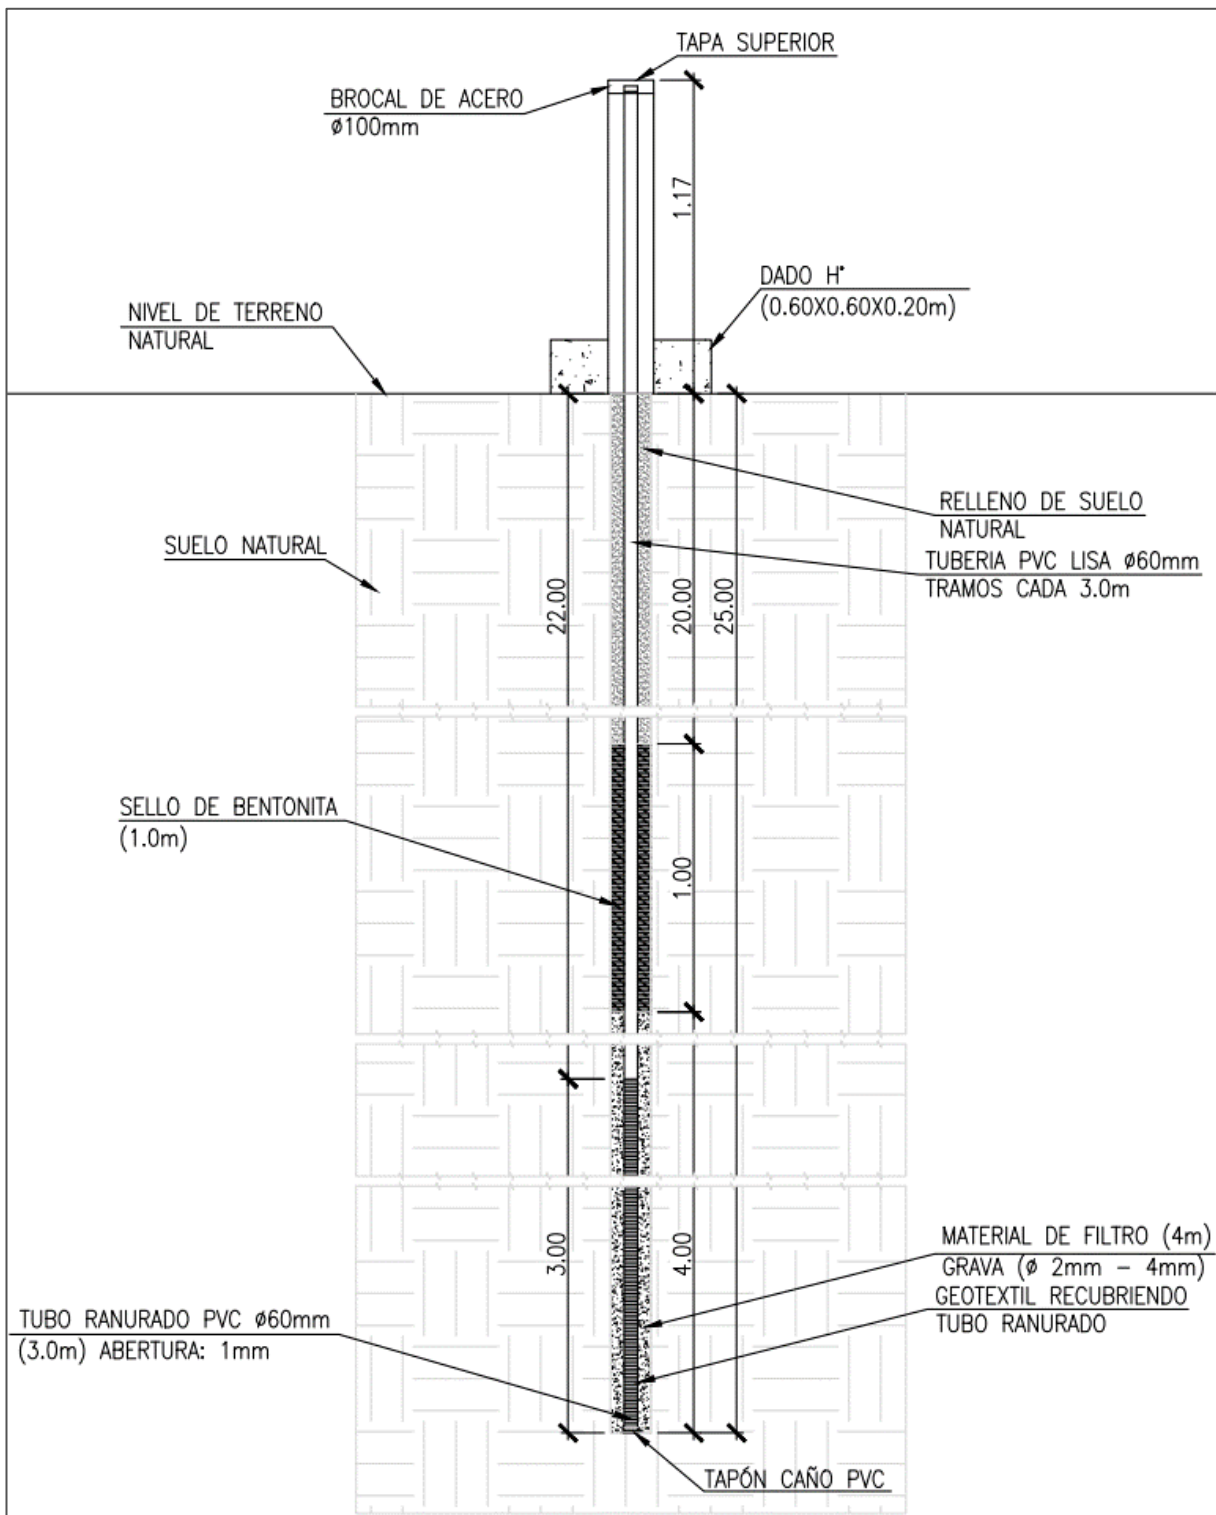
Esquema en detalle del perfil SRK-2023-BH07
